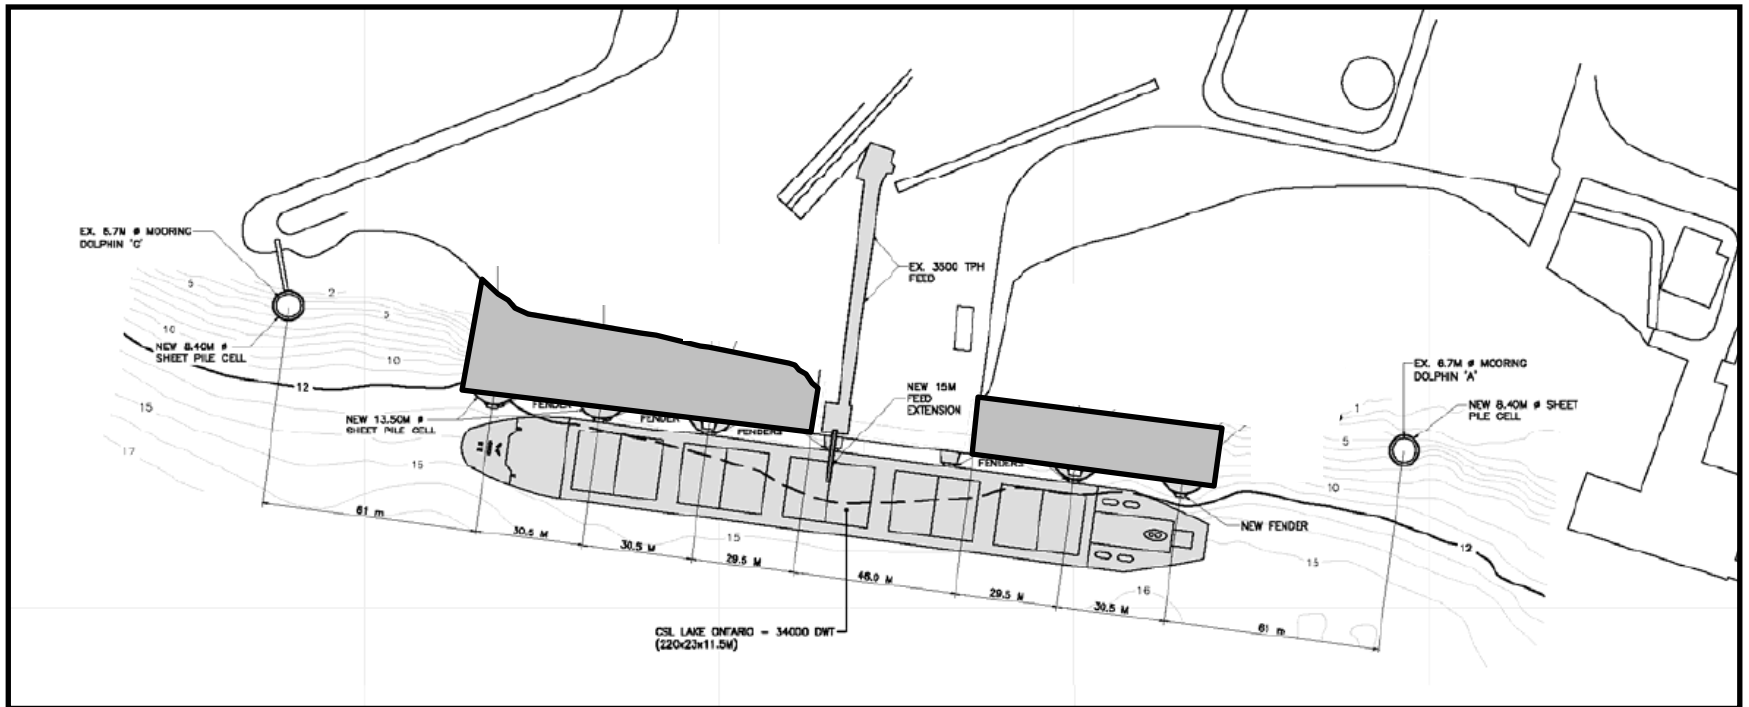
Plan de la variante de configuration « pleine extension latérale du quai »
